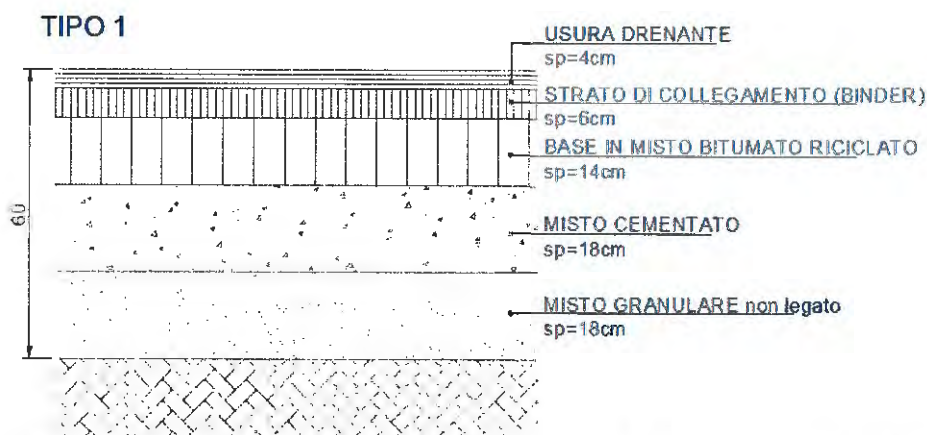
Sezione TIPO 1 proposta variante migliorativa– Asta principale SS131 e Rampe Svincolo Nord
